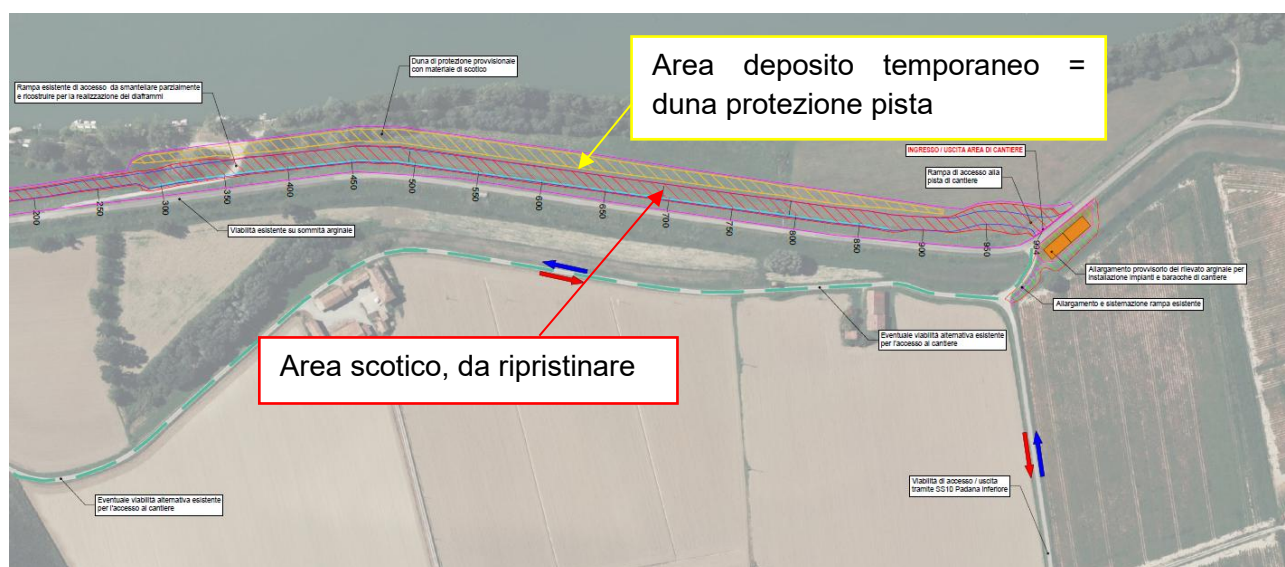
Estratto dalla tavola PE.0.1.6.SIC.GE.P.L.0.0.1 “Layout di cantiere” – area nord Caorso.
